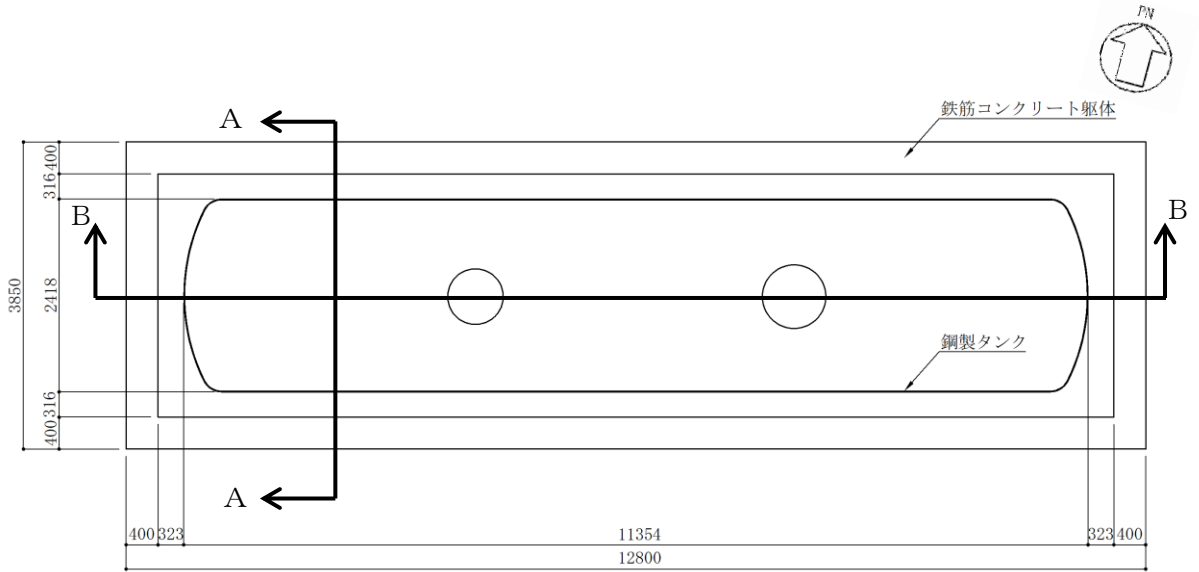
緊急時対策所用燃料地下タンク 平面図 (単位: mm)
